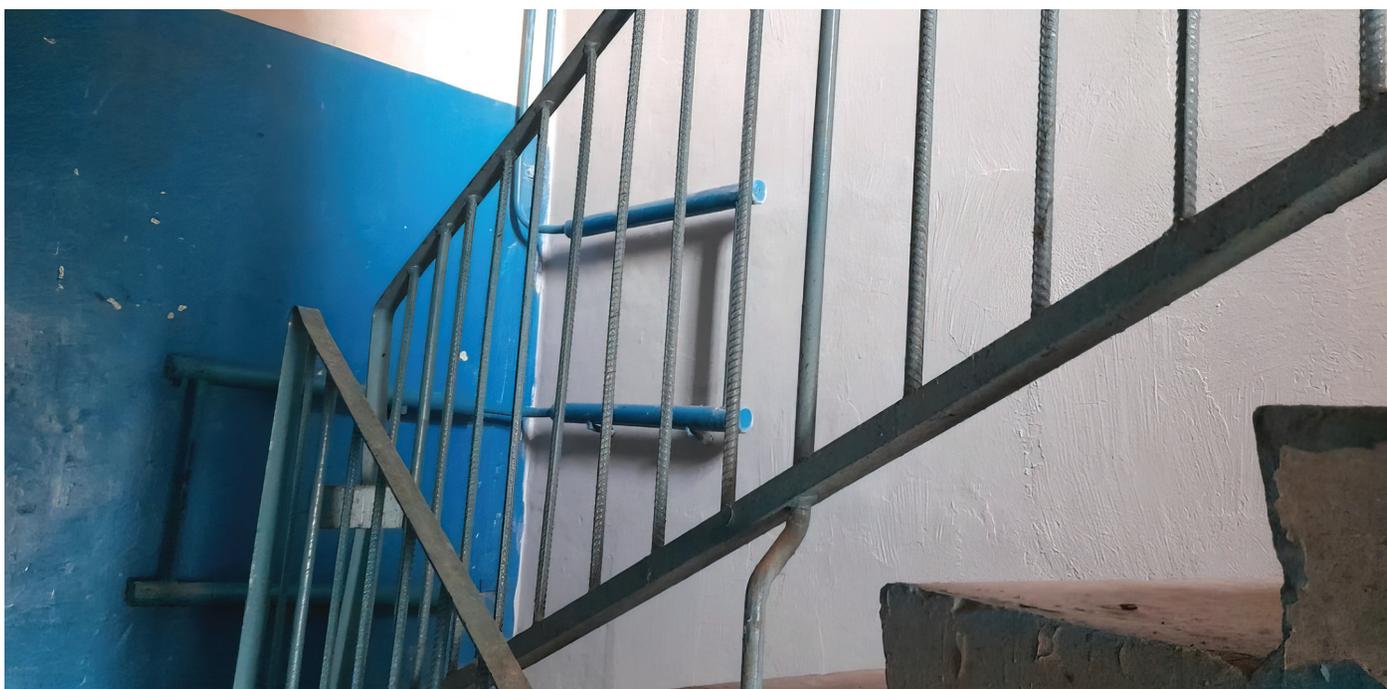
Окраска стены лестничного пролета в МКД по ул. Промышленная, 55 специальной теплоизолирующей мастикой. Фото: ИЭГ
